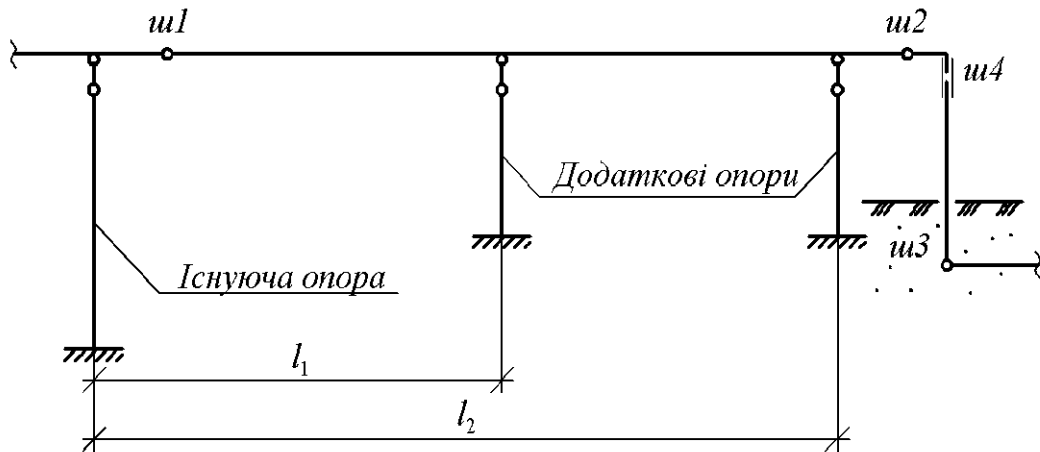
Фрагмент розрахункової схеми № 2 надземного переходу трубопроводу.
